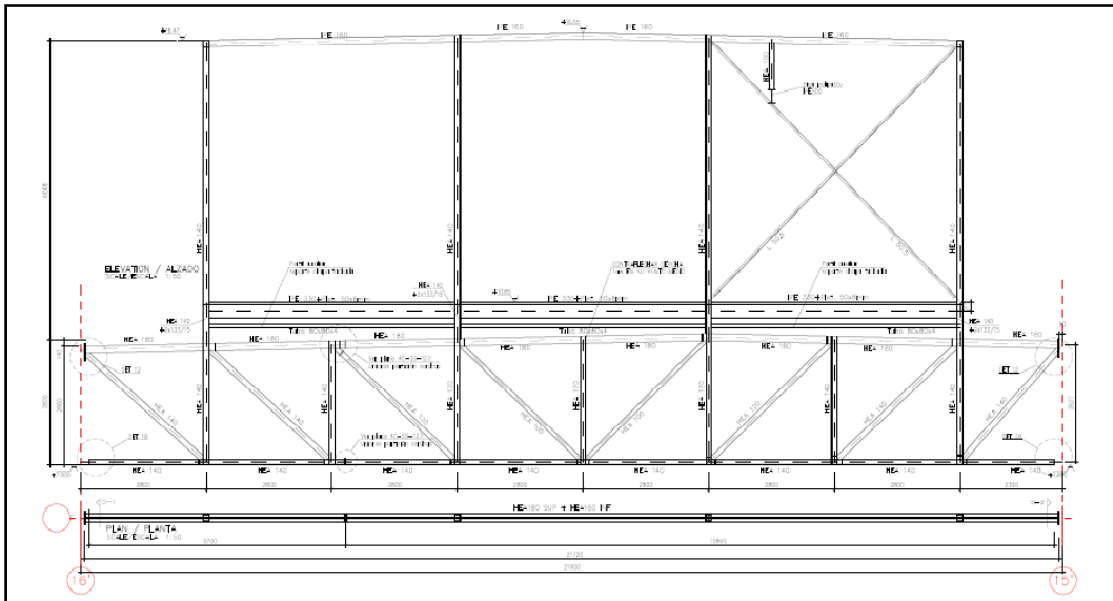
Alzado de celosía 2, incluyendo sub-estructura que descansa sobre ella.
